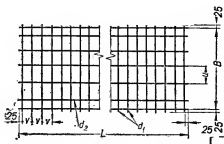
Сварная сетка с поперечной рабочей арматурой.
